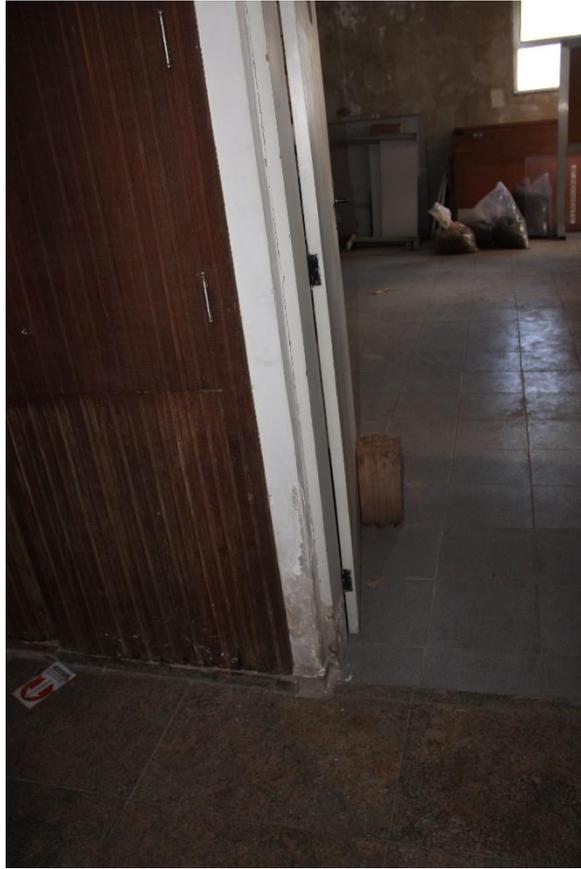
Umidade na base da parede – sala 6º pavimento (arquivo)
